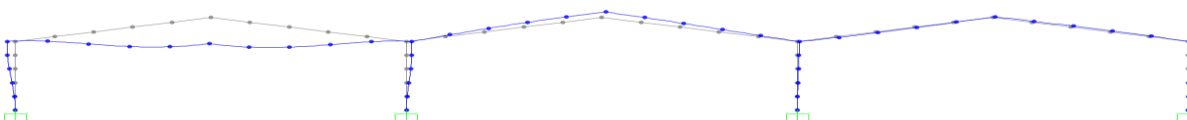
Configuração deformada devido ao carregamento vertical – W (Pórtico PE1)
